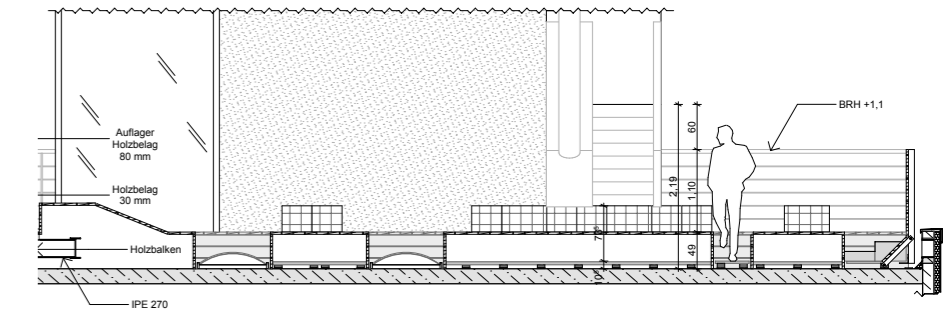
Dachgarten, Schnitt © RaumstarArchitekten
